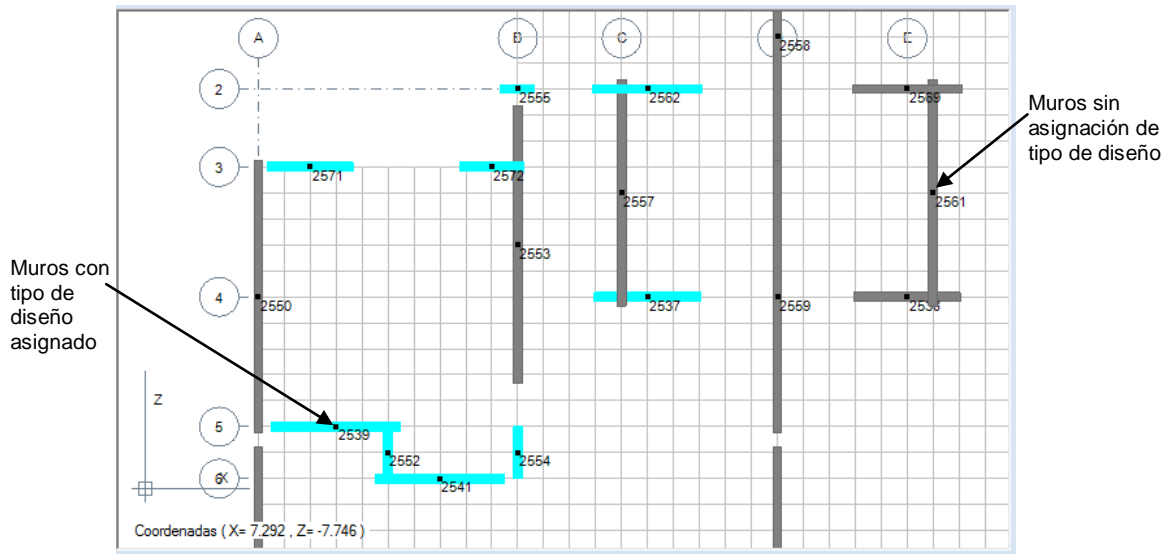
Vista en planta de muros con un tipo de diseño asignado
